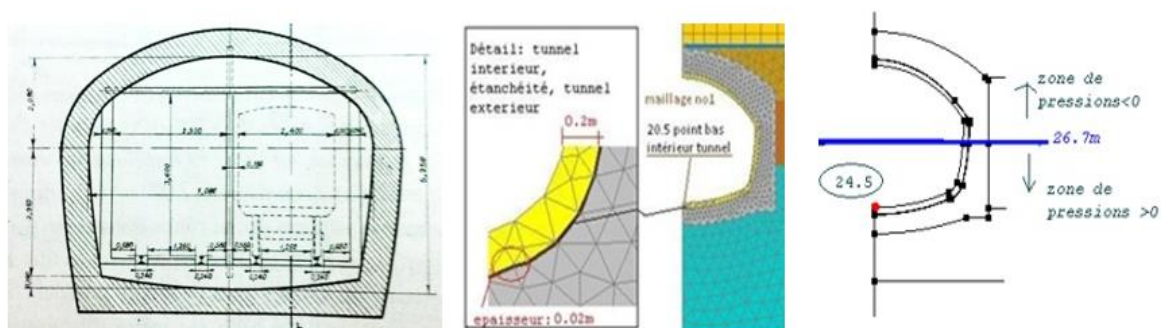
Tunnel d'Austerlitz : Coupe à deux voies et structure.
